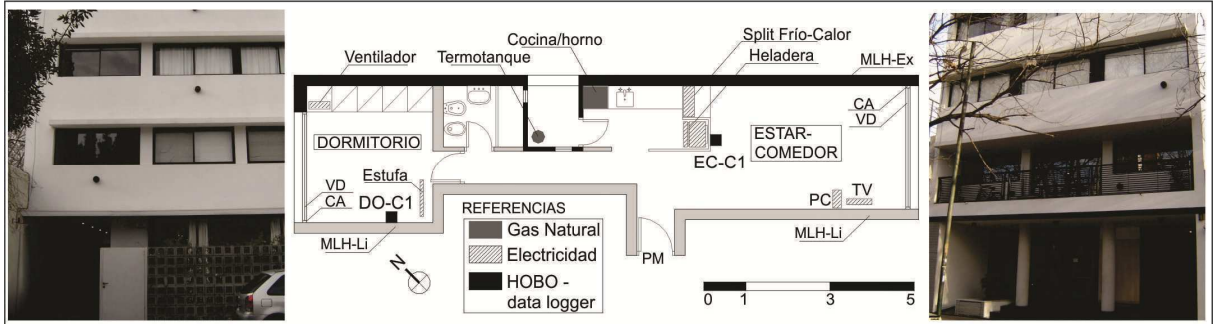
Dpto.1 – Planta e imágenes exteriores. Indicación principales materiales y equipamiento.
